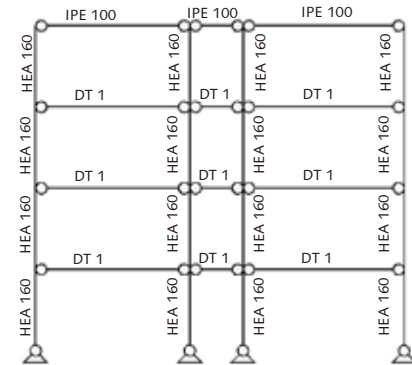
Grundriss Rahmen I - Haus 1
